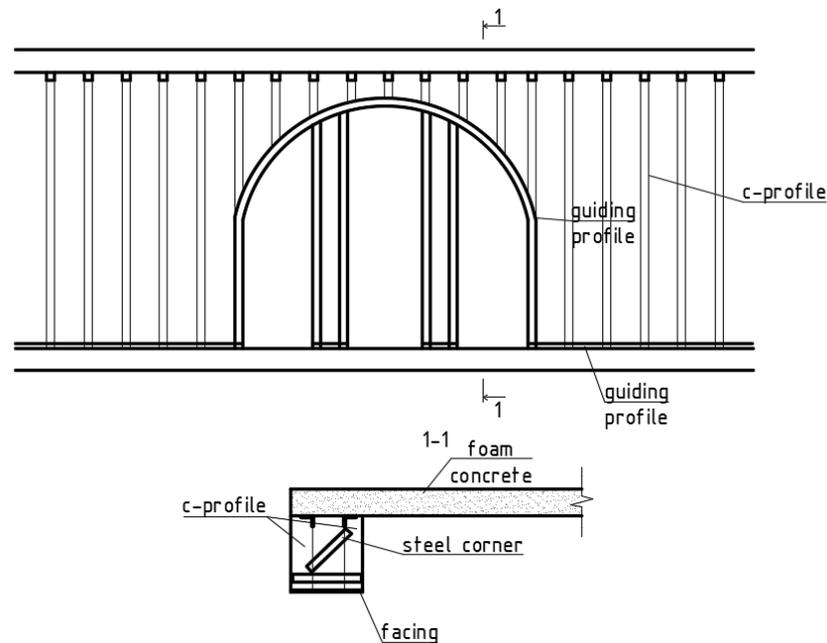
Конструкция усиленной стены из заливного пенобетона
